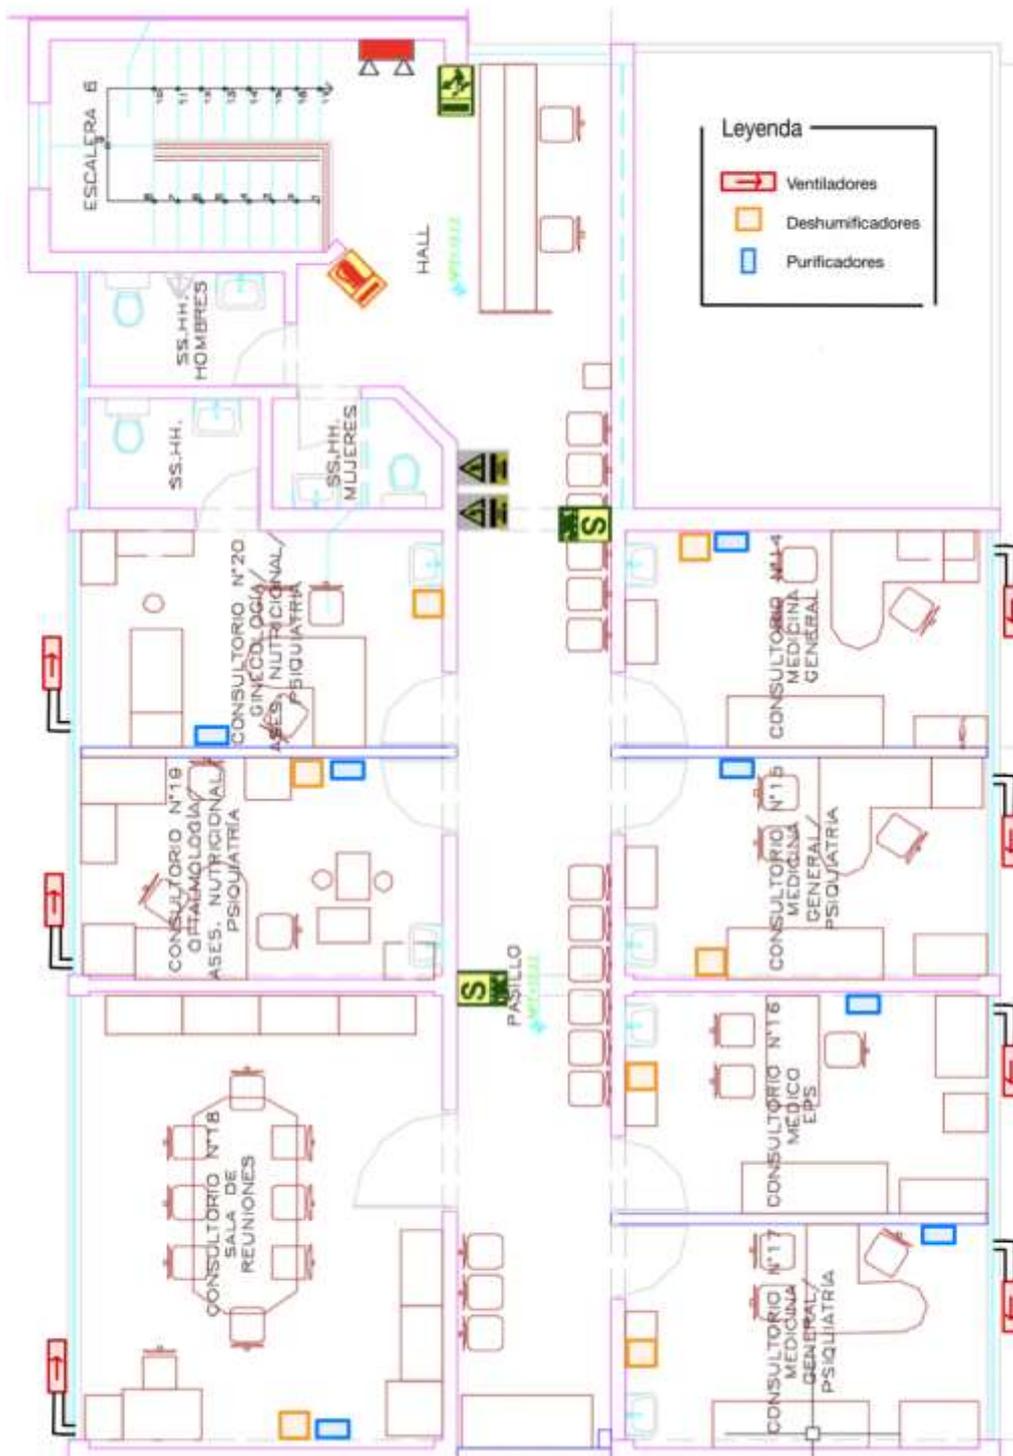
Plano con propuesta segunda planta centro de salud.
